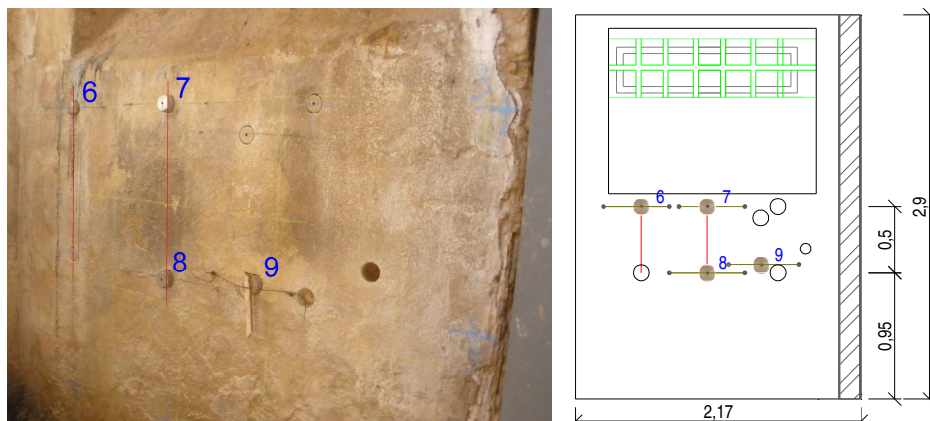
Marcações verticais e “pastilhas” coladas na Parede 5 – vista v1
